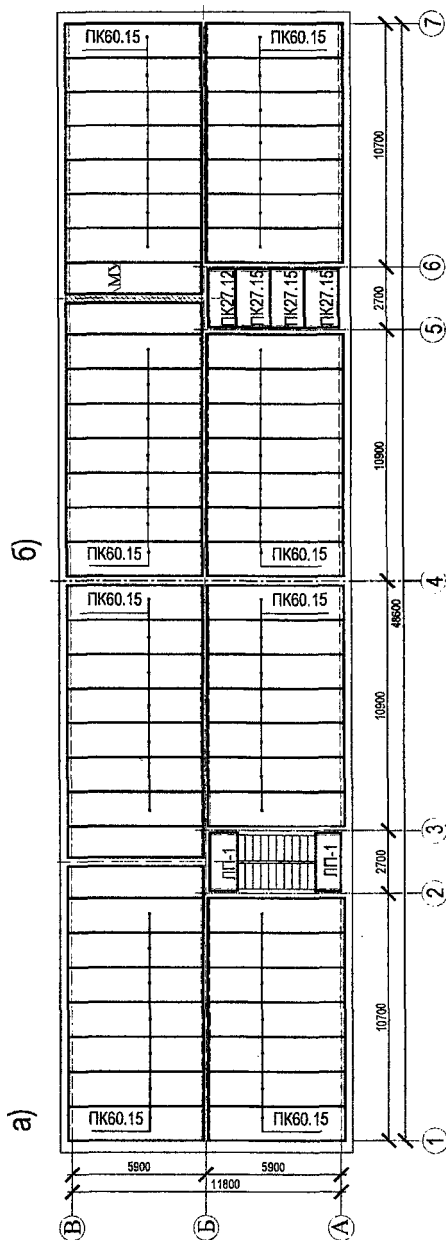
Схема раскладки плит перекрытия и покрытия:
